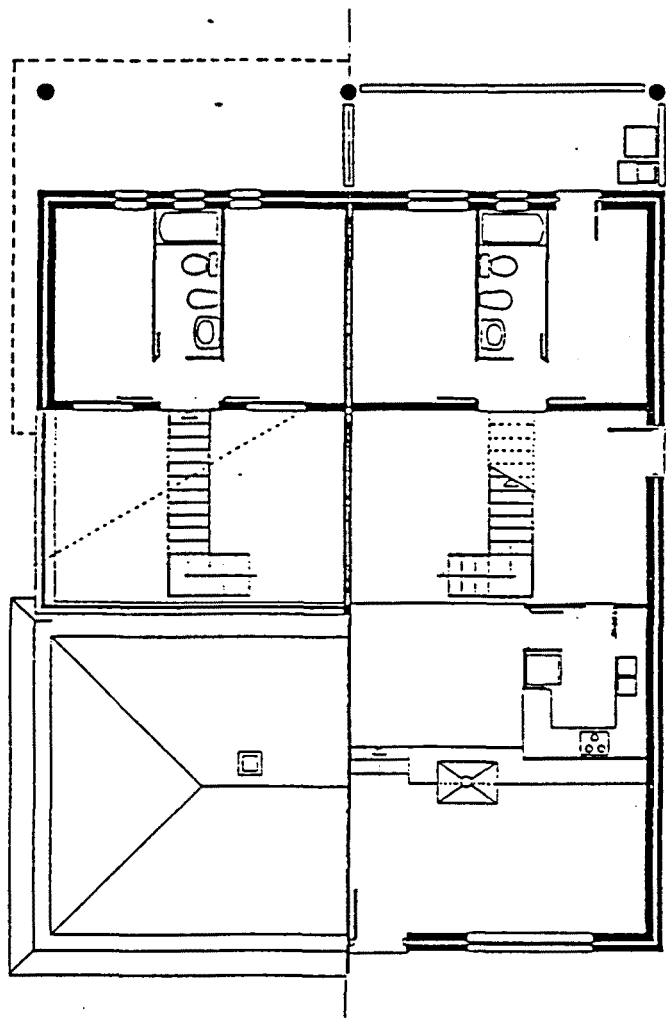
Plano de las casas de tipología de patio central cubierto.
